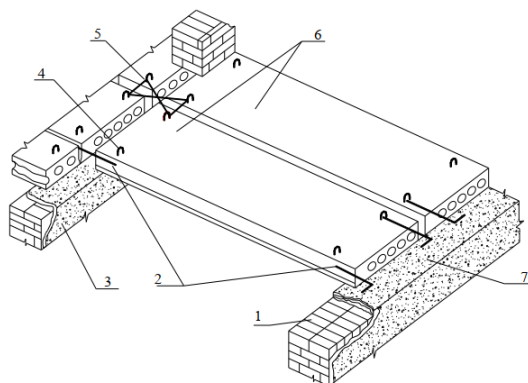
Міжповерхове перекриття по залізобетонних панелях:
